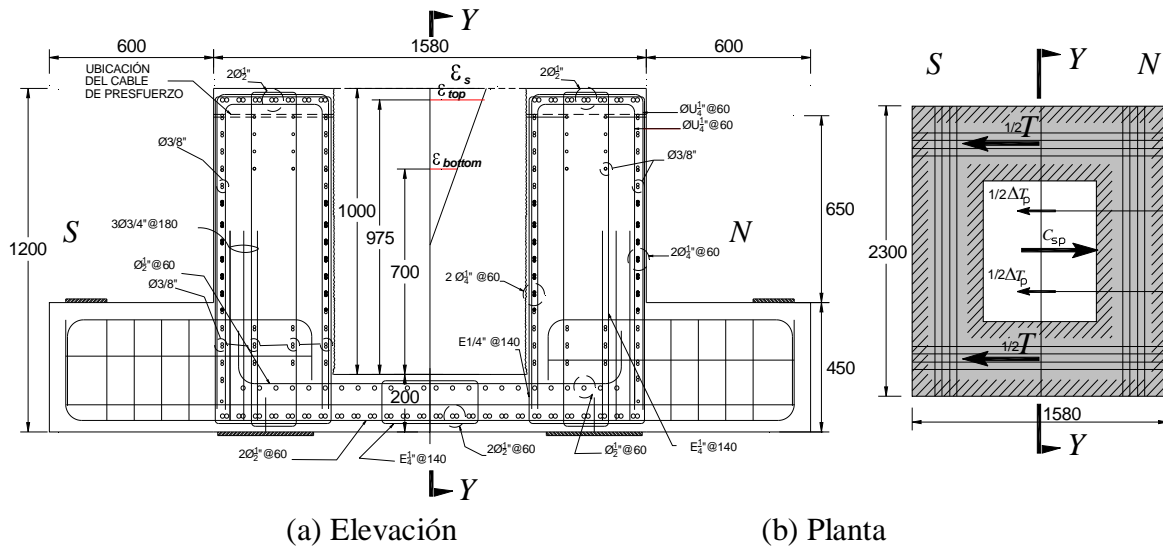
Cimentación tipo candelero, a escala 1 / 2.5 (dimensiones en mm)
